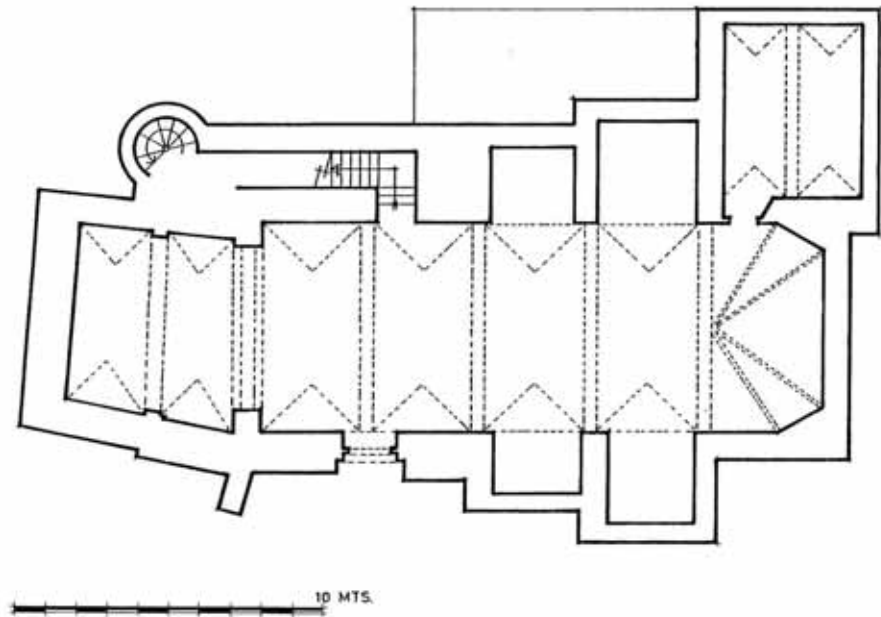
TABAR. Parroquia de San Juan Bautista.
